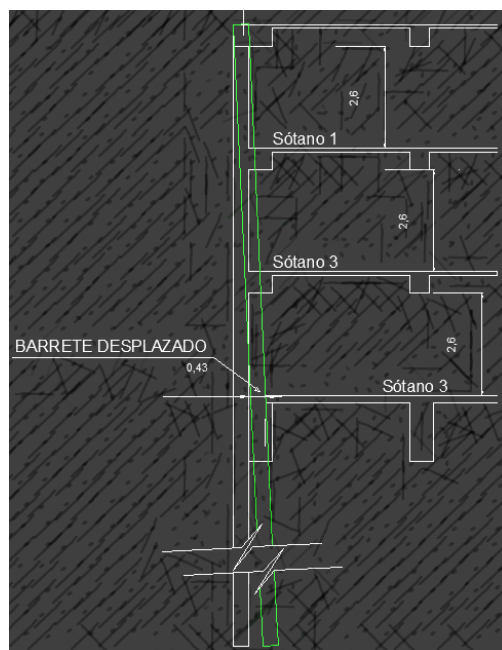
Corte de barrete desplazado. Fuente: Propia.
